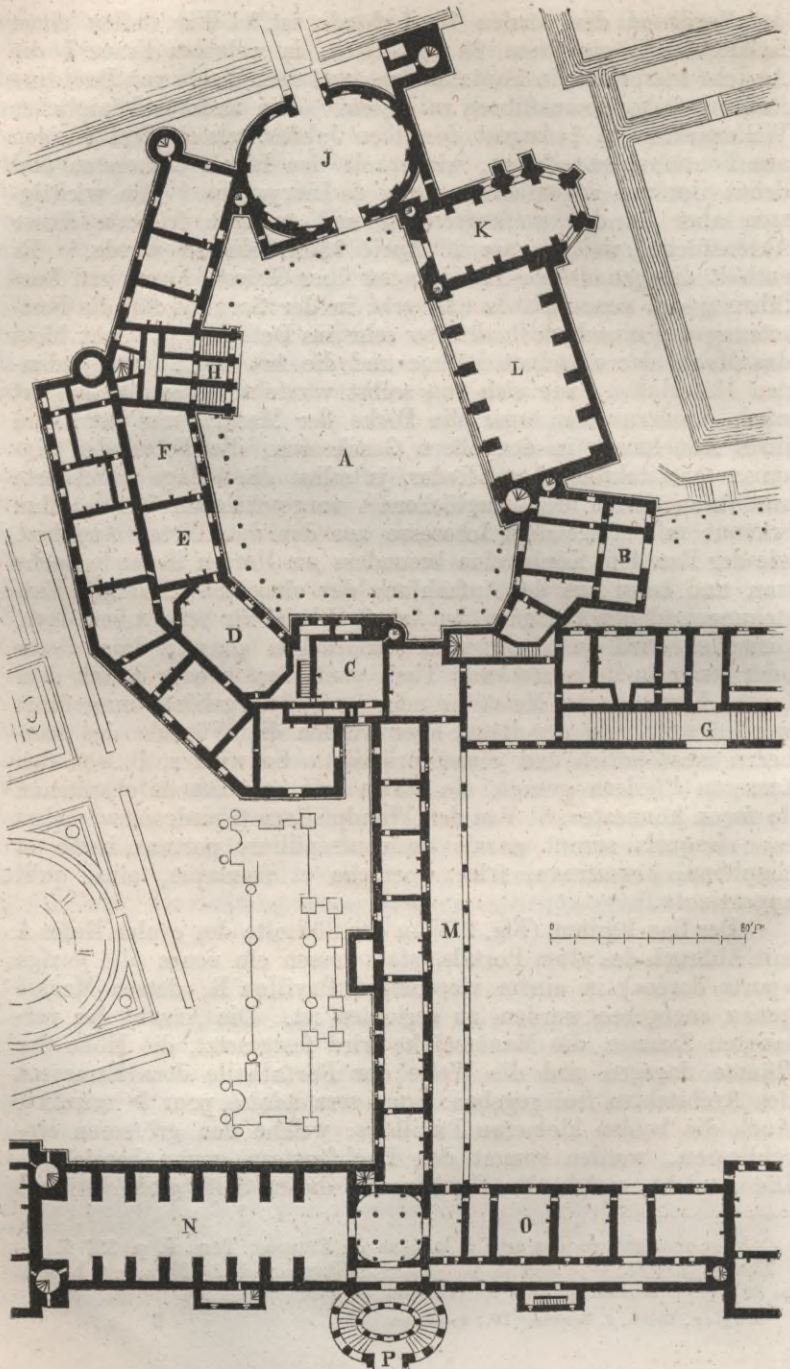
Fontainebleau. Grundriss der älteren Theile. (Du Cerceau.)
